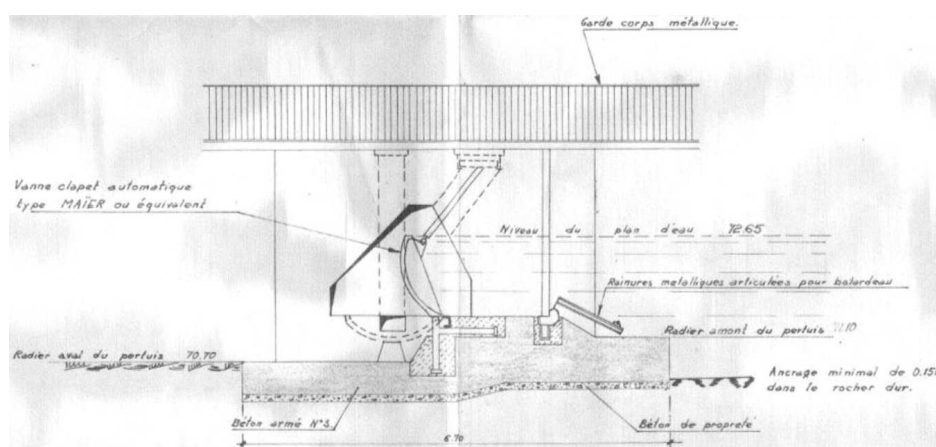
Coupe schématique de la vanne du plan d'eau. Plan d'exécution – Nov. 1968
